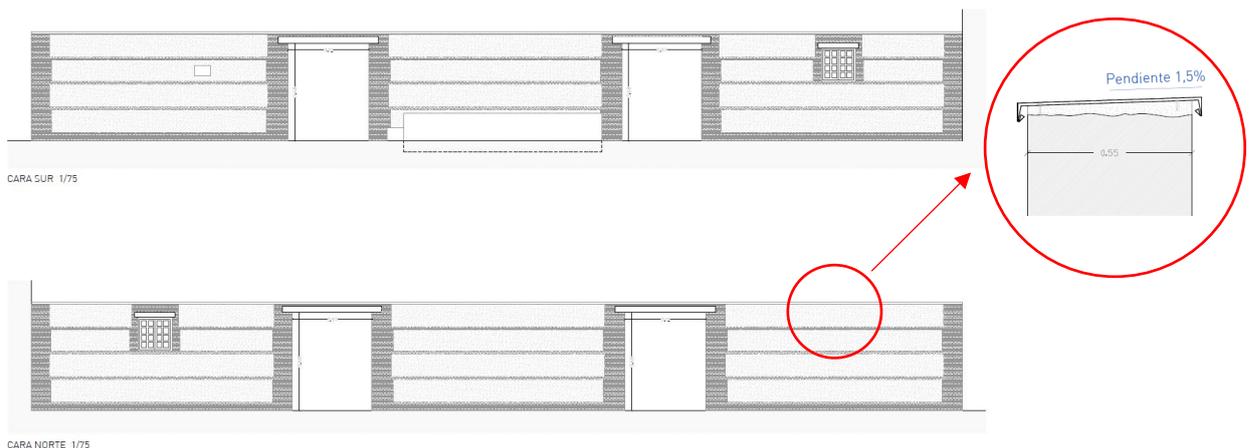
Propuesta en muro y fuente en el Jardín de Jovellanos.
